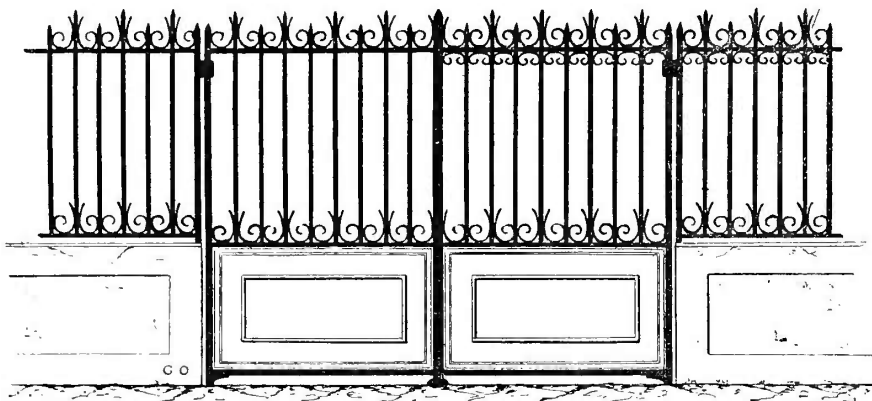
Grille d'entrée de parc à deux vantaux et avec mur d'élévation, sans pilastres.
